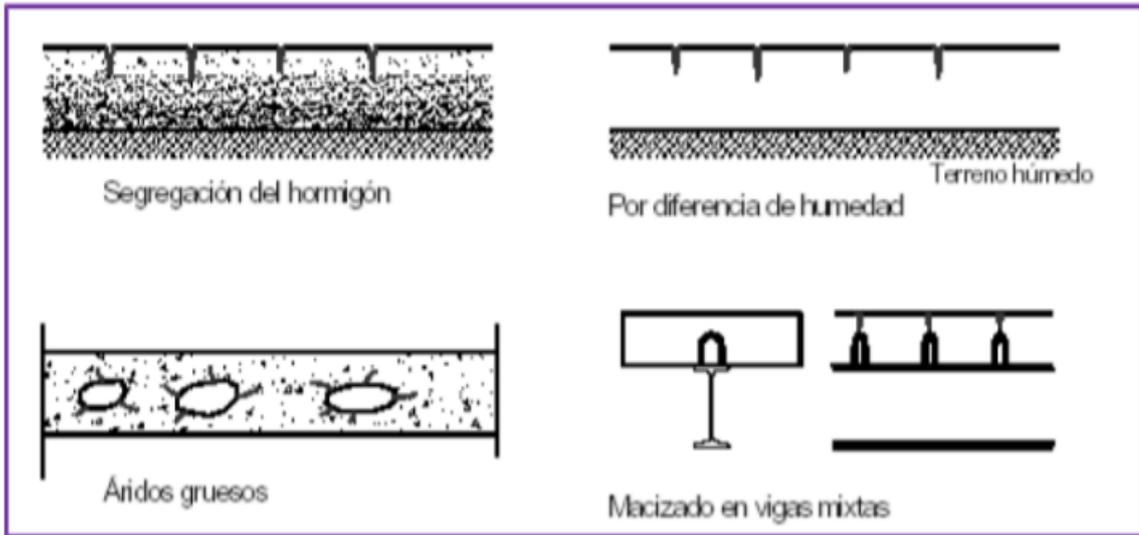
FISURAS CON RETRACCIÓN HIDRÁULICA TECHOS O PISOS
